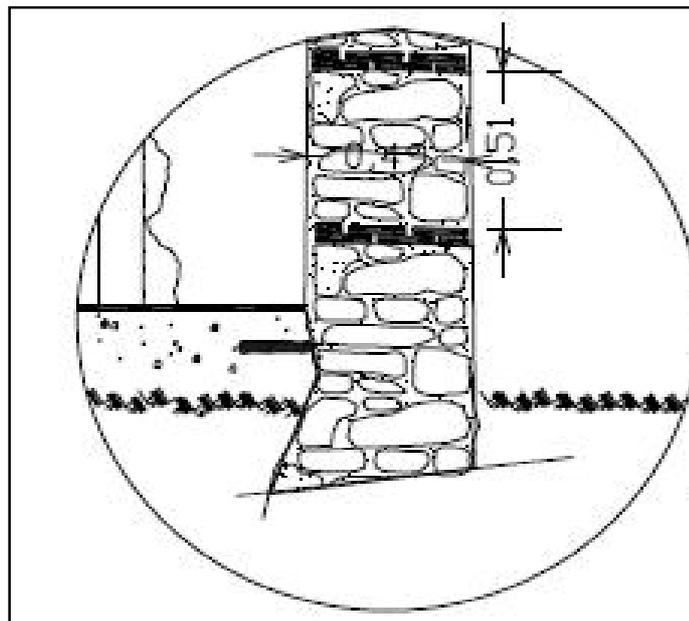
Coupe longitudinale sur un mur mixte échelle 1/20
